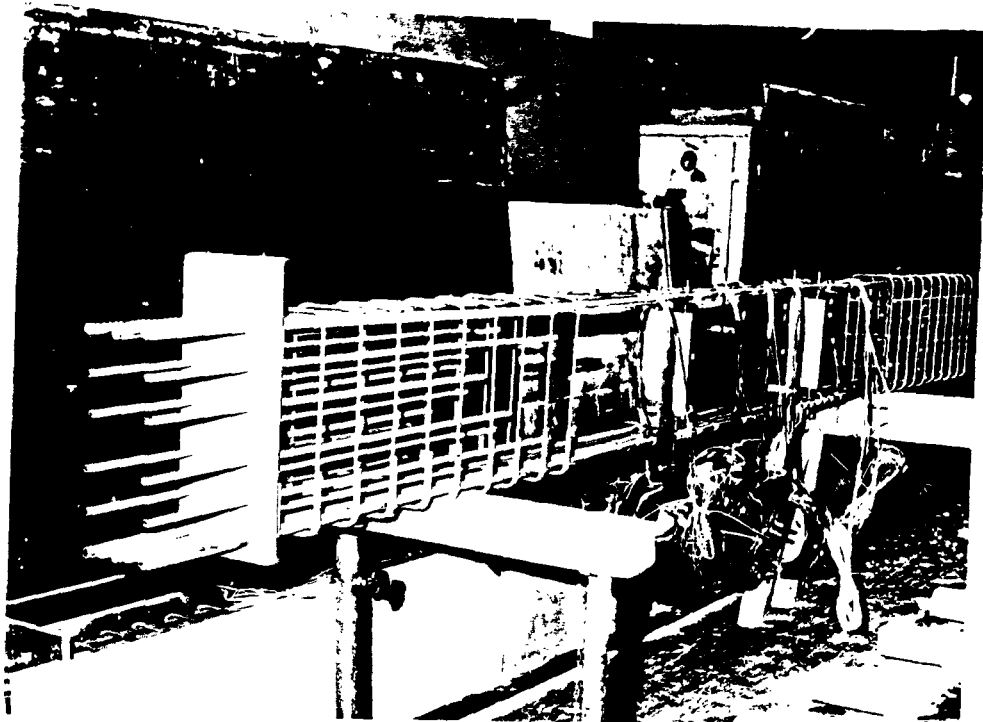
Bewehrungskorb und Schalung mit eingesetztem Bewehrungskorb der Versuchskörper
